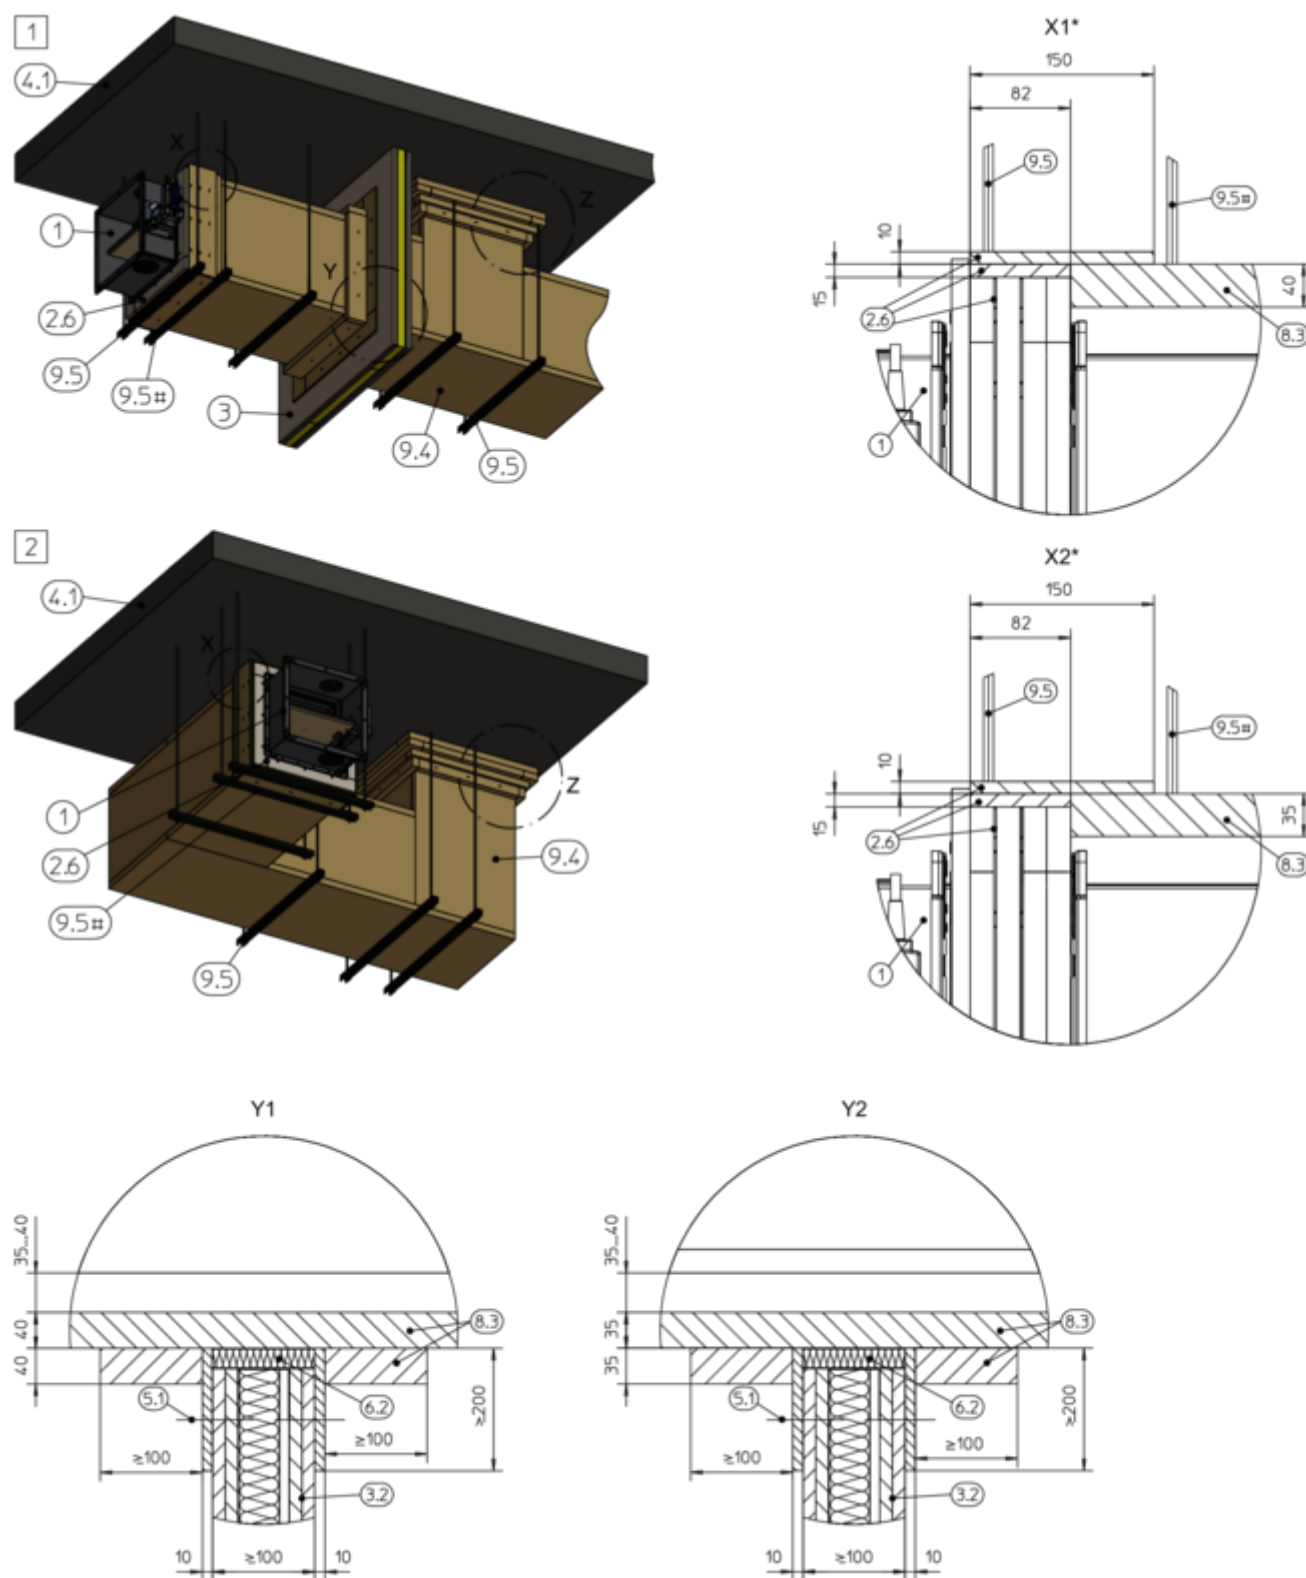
Montage à sec sans mortier sur une dalle de plafond pleine avec kit de montage WA
